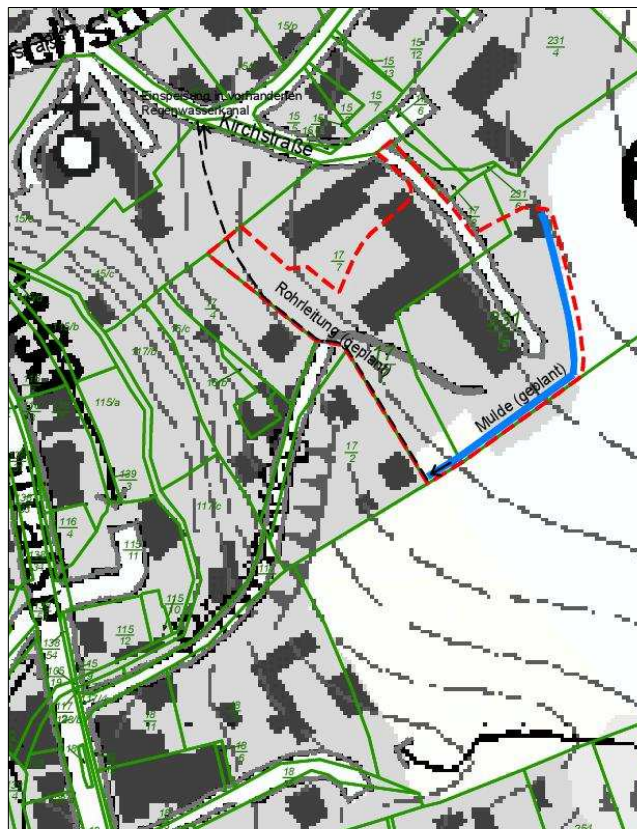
Favorisierte Lösung zur Einspeisung des aus der geplanten Mulde am Ostrand des Plangebietes austretenden nicht versickerten Wassers (Maßstab 1:2.000)
